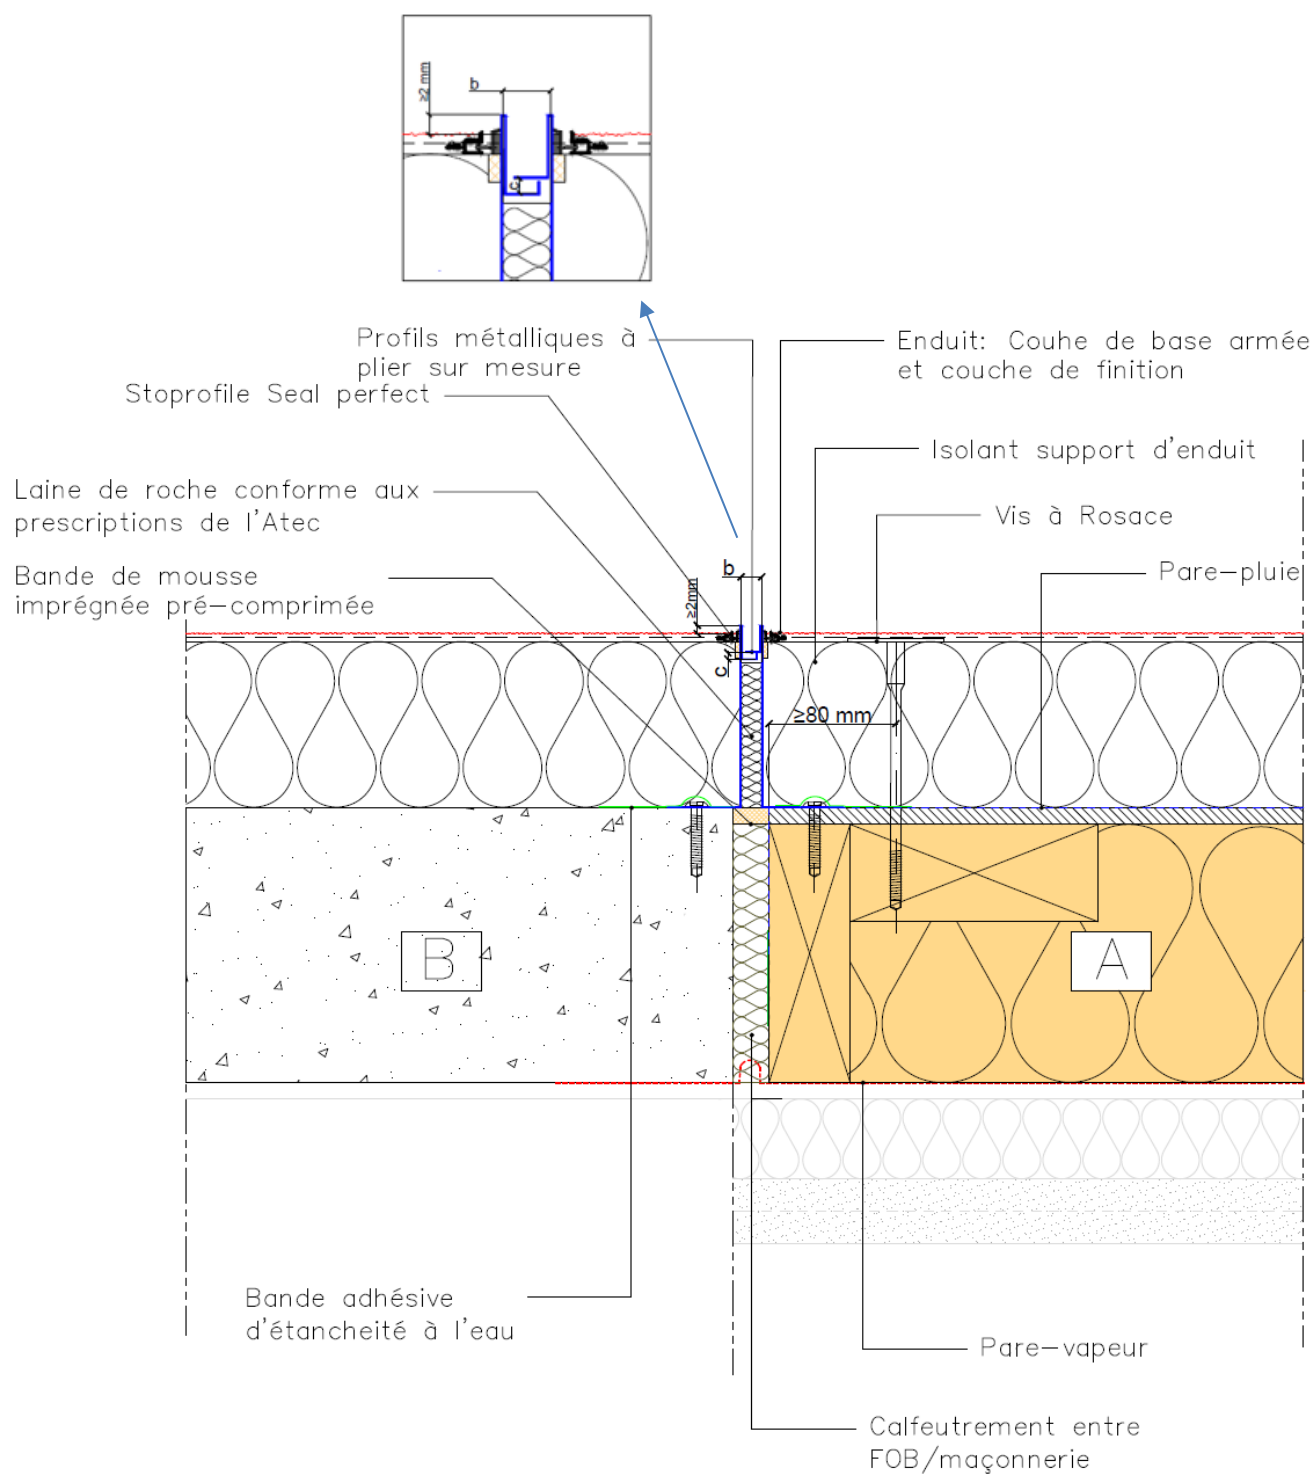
Jonction FOB / Voile BA (ou maçonnerie) dans le même plan et avec ETICS - Profil acier - Coupe Horizontale
